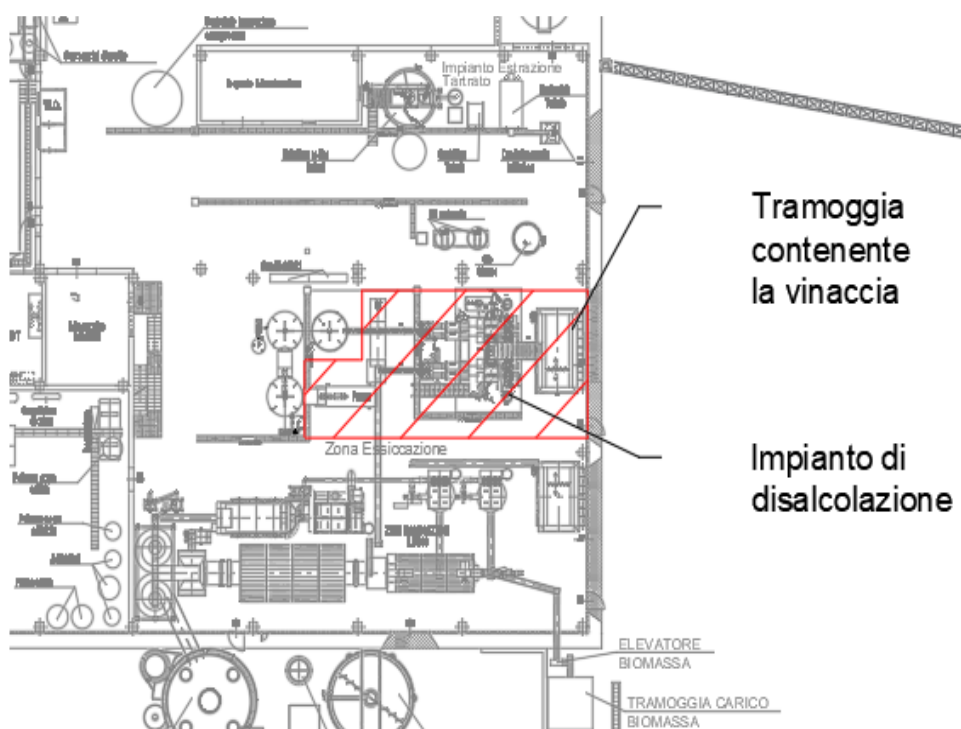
Localizzazione in planimetria della sezione disalcolazione
